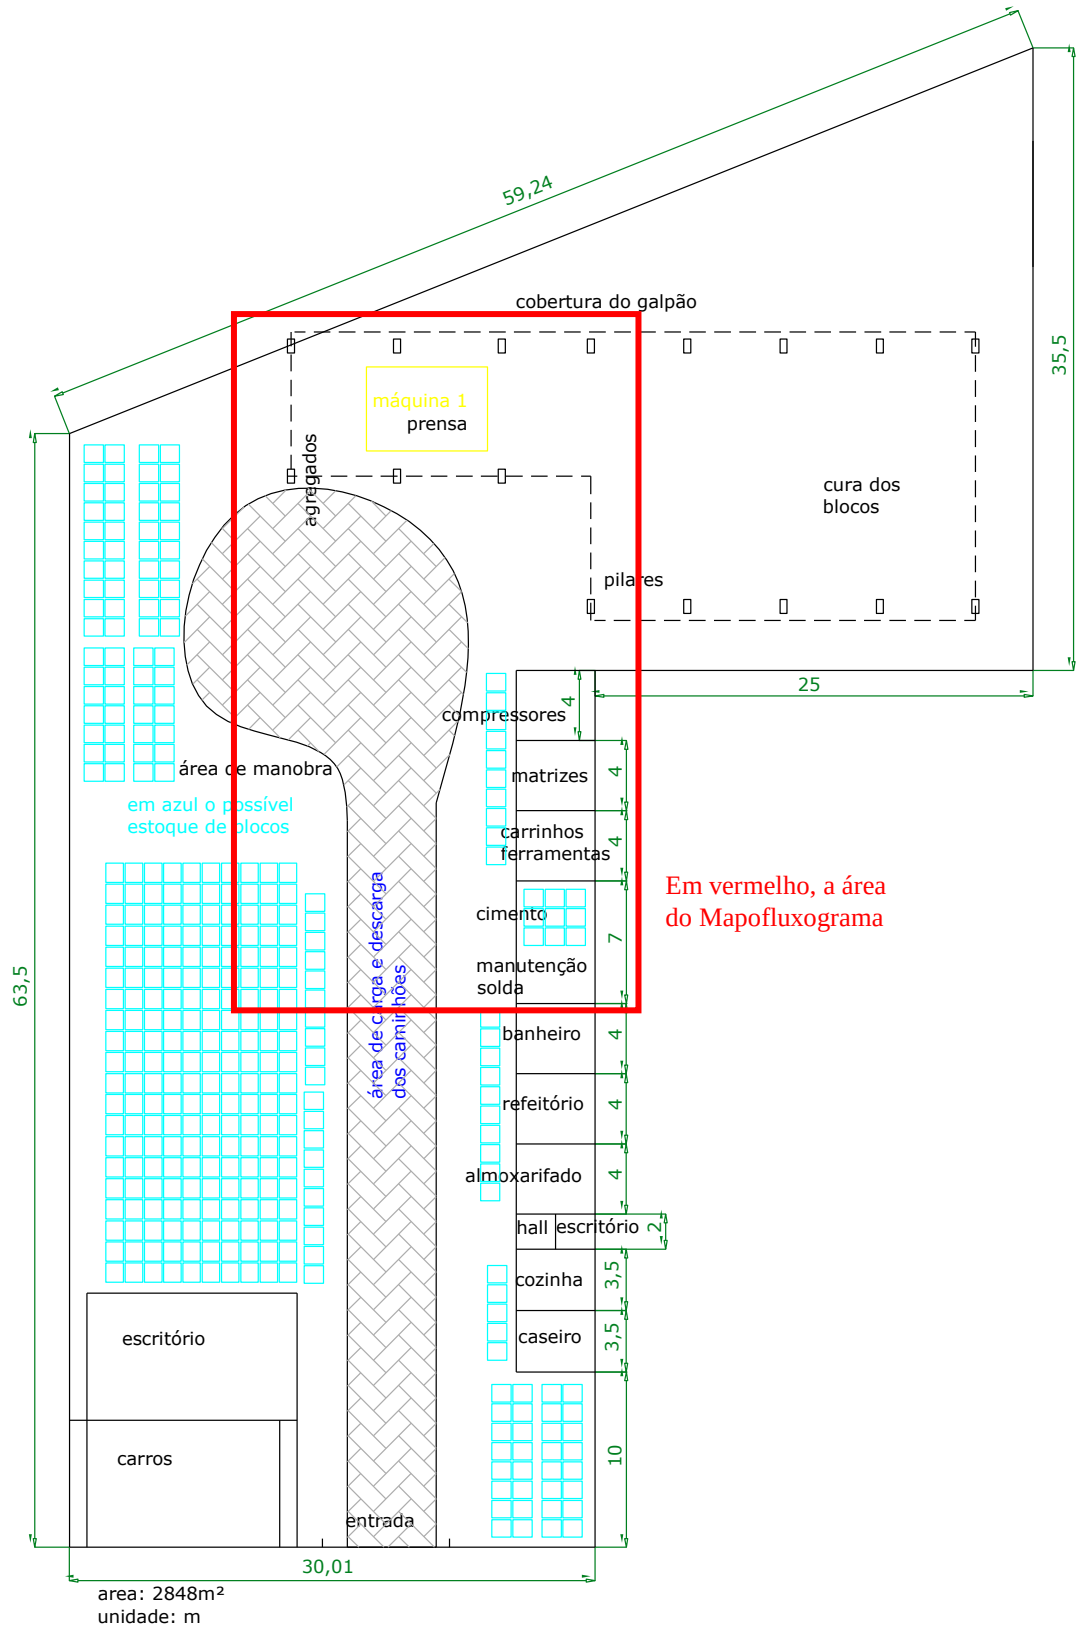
Planta da empresa. Fonte: Bloco-Art
